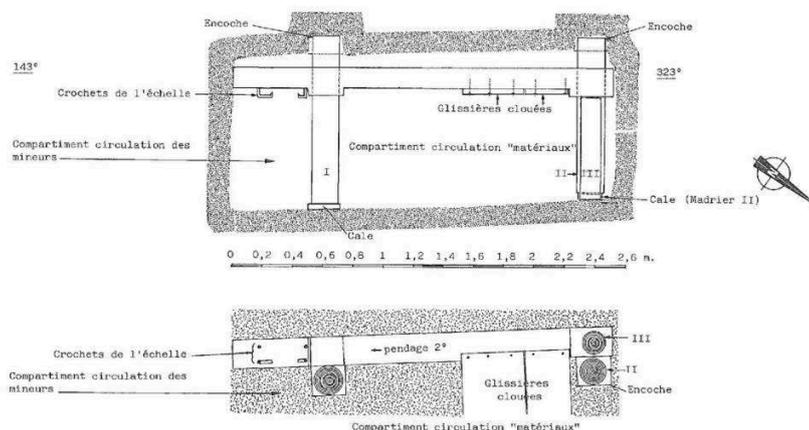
Plan et coupe du puits au niveau du premier boisage.
